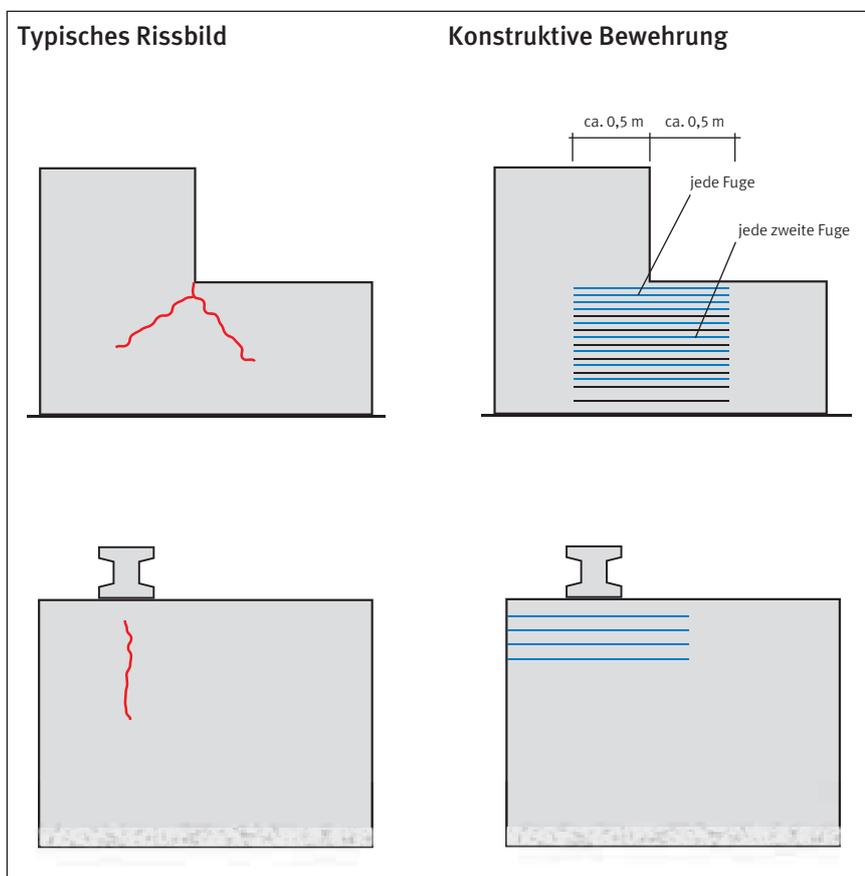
Konstruktive Lagerfugenbewehrung im Bereich von Höhenversprüngen und konzentrierten Lasten
